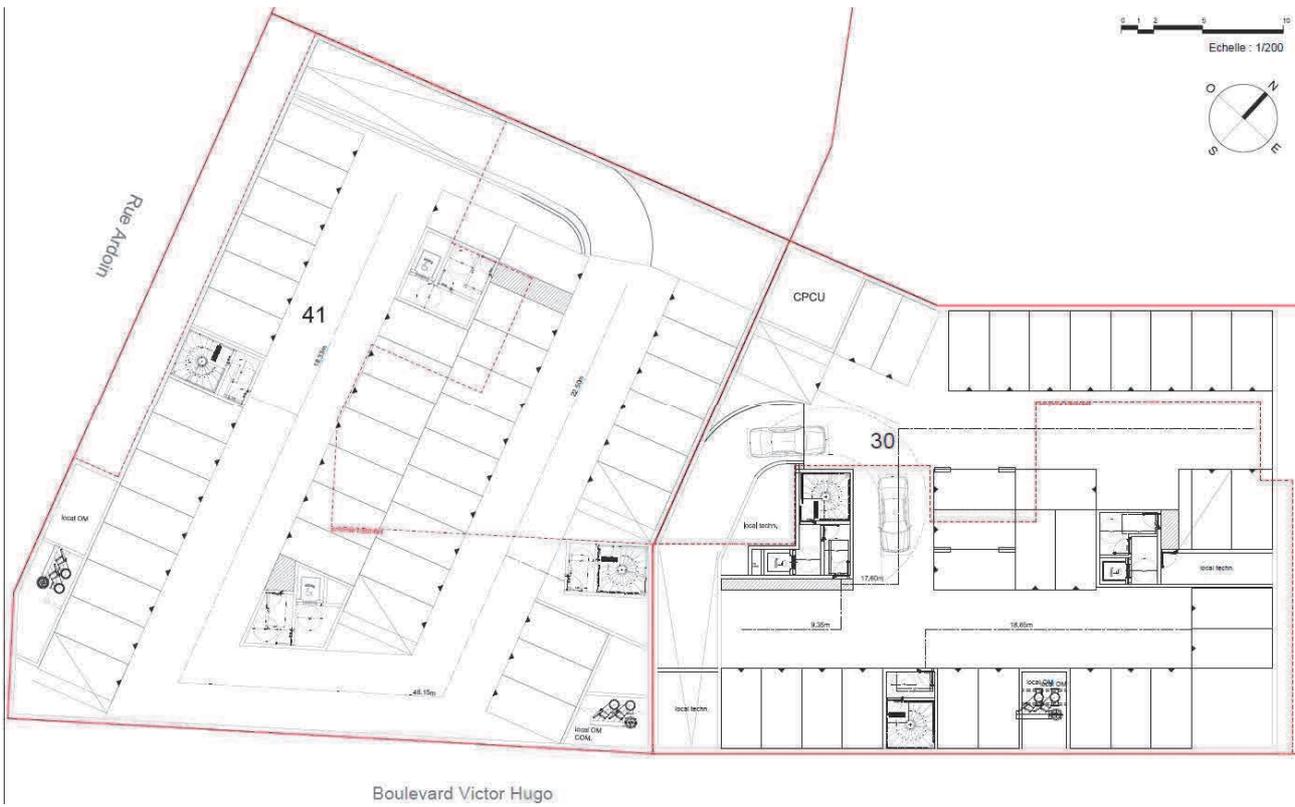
Plan du sous-sol du Lot B2AB (Source : DGM)
